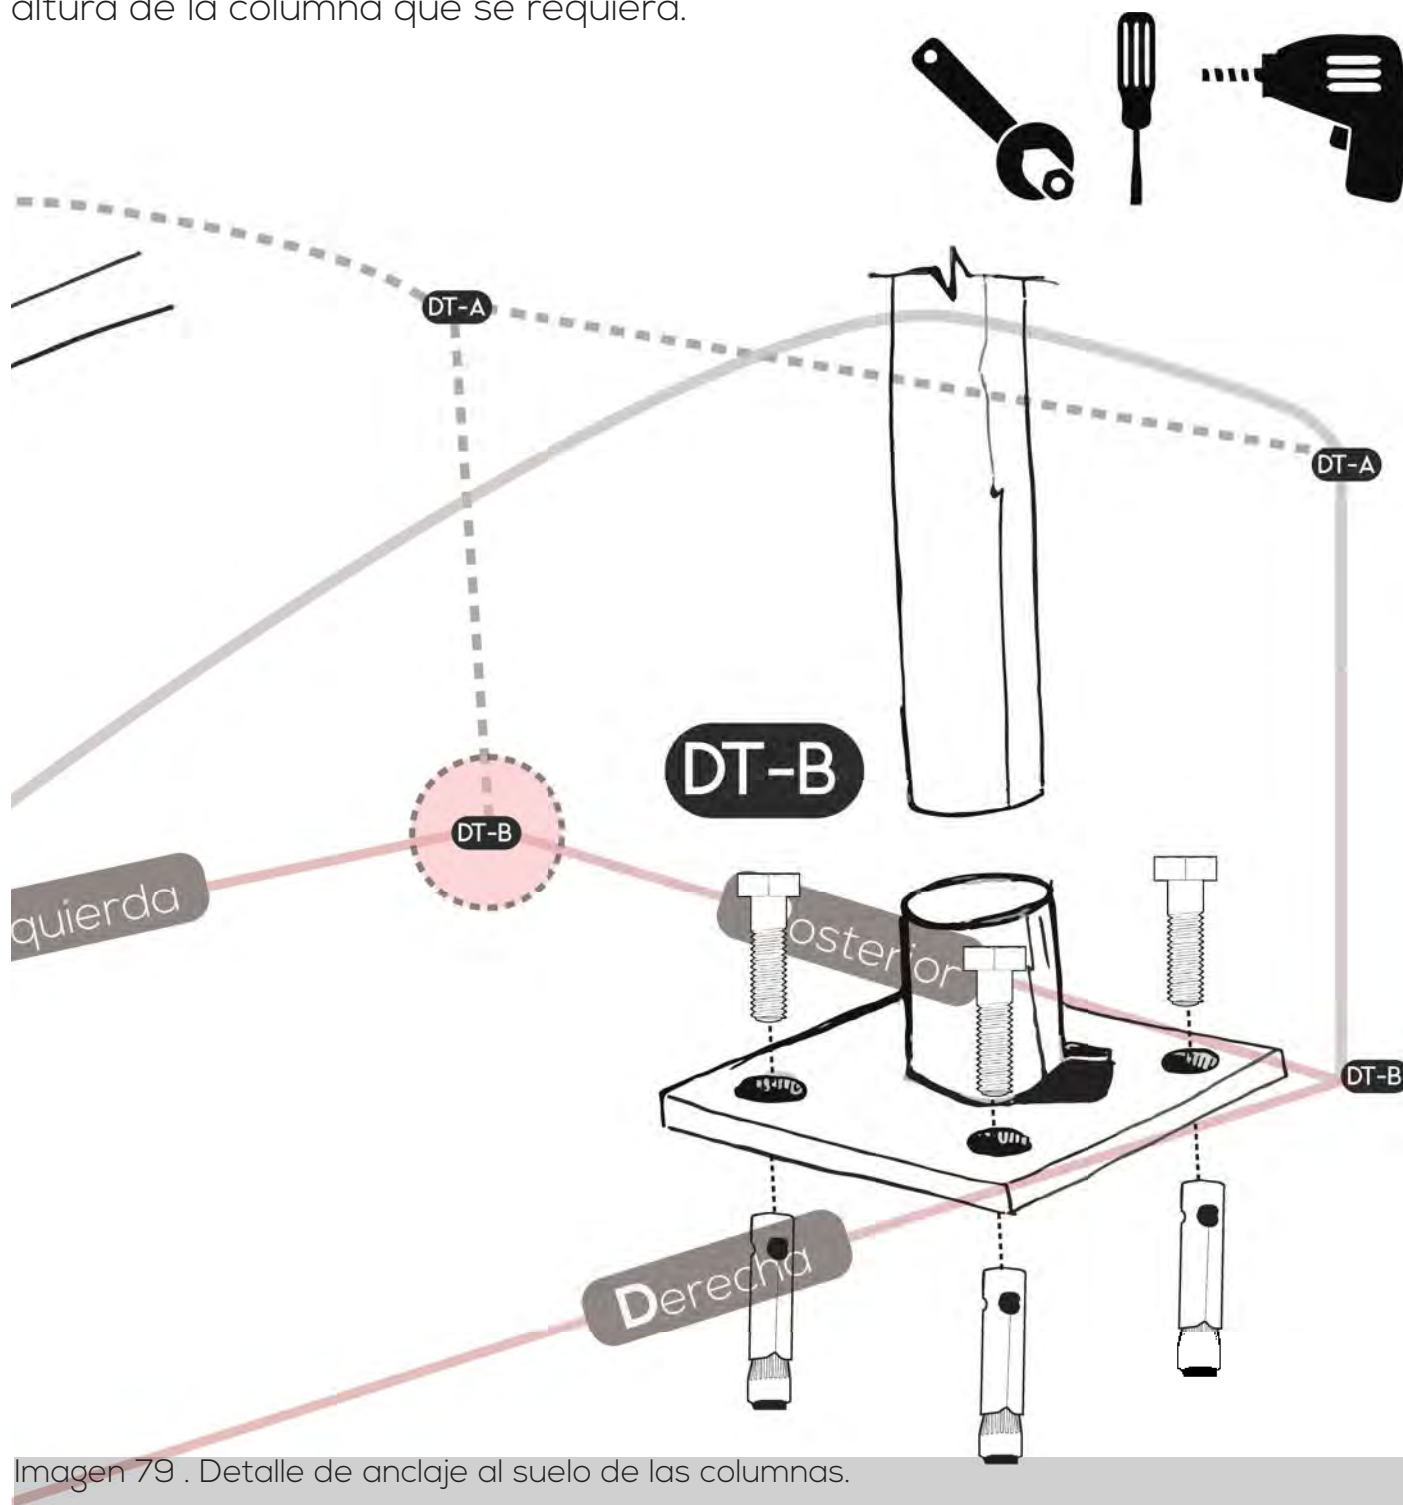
Detalle de anclaje al suelo de las columnas.
